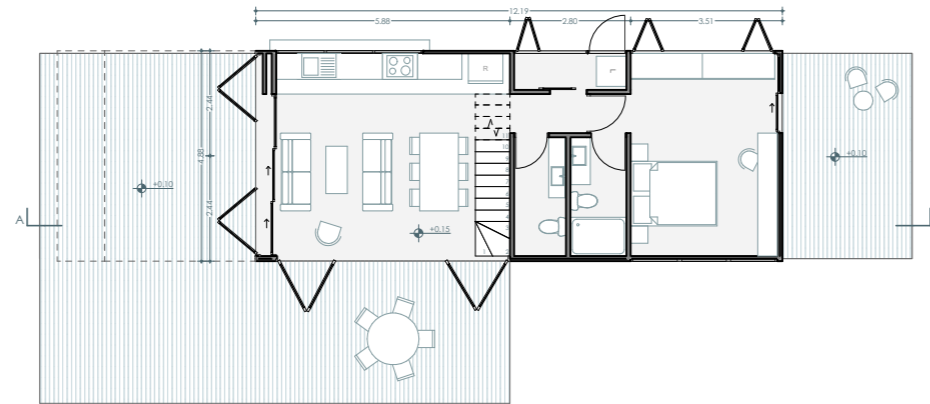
Planta baja Casa Huiini. Fuente: Autores, 2023
